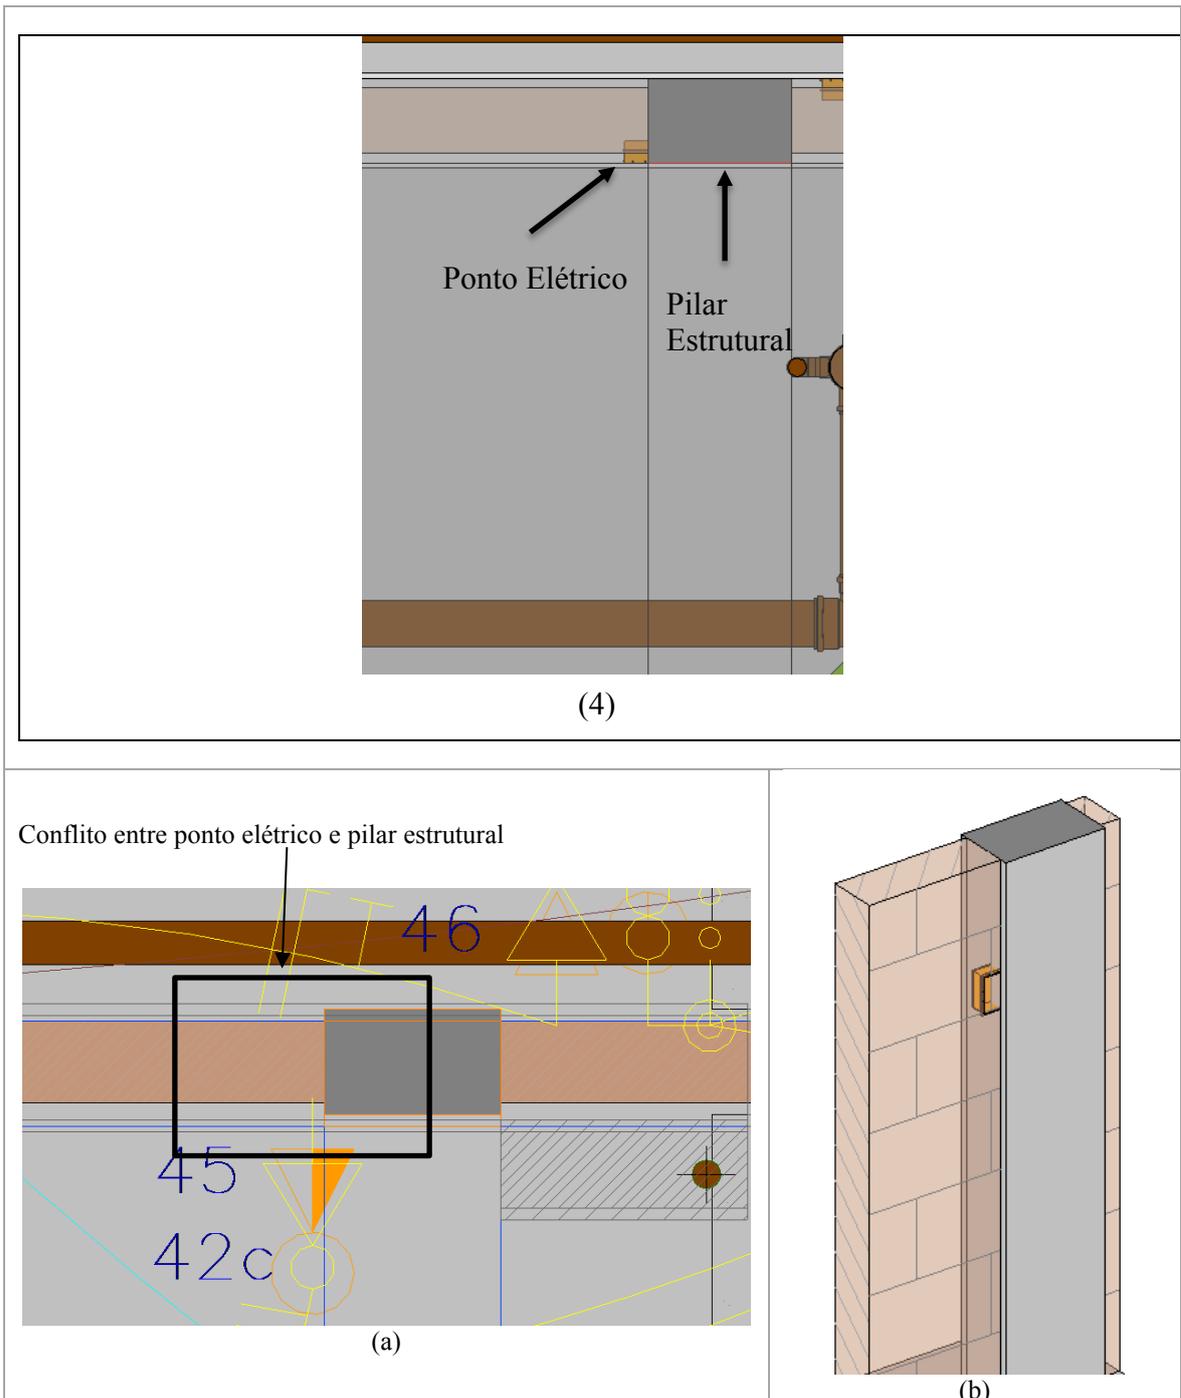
Confronto entre ponto elétrico e pilar estrutural em planta baixa (a) e em vista tridimensional (b). Fonte: elaborado pelos autores.
